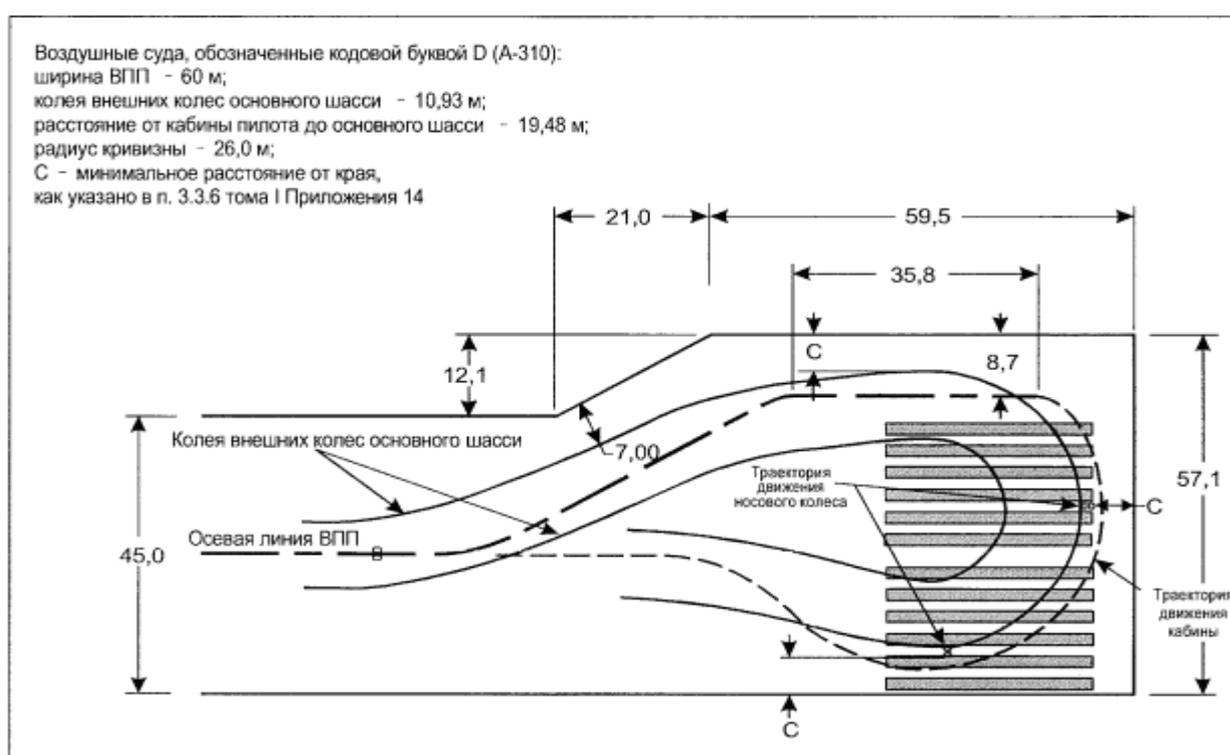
Схема маркировки площадки разворота на ВПП для воздушных судов, обозначенных кодовой буквой D
